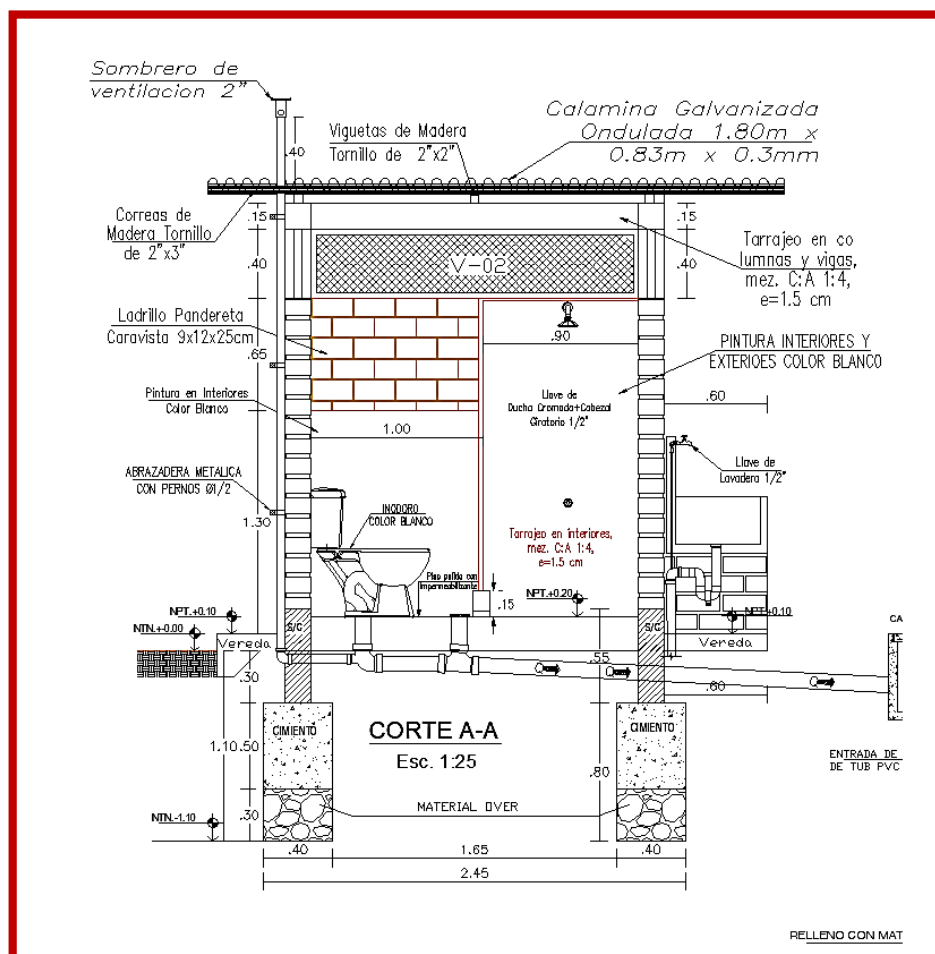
Corte de la UBS con Arrastre Hidráulico con Zanas de Percolación.
